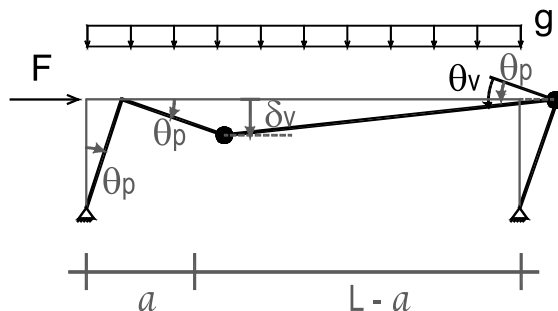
Configuração deformada de um pórtico correspondente à formação de rótulas plásticas unidireccionais
